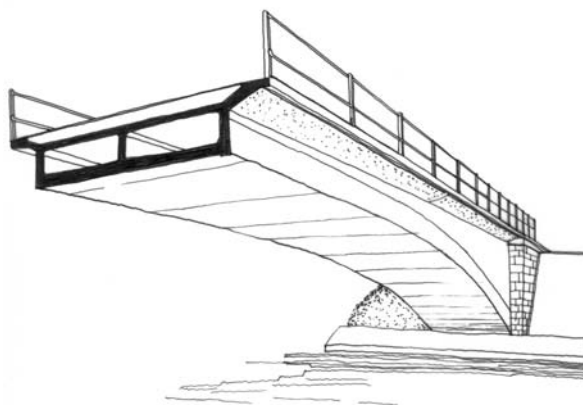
R. Maillart: sezione trasversale Ponte Zouz
